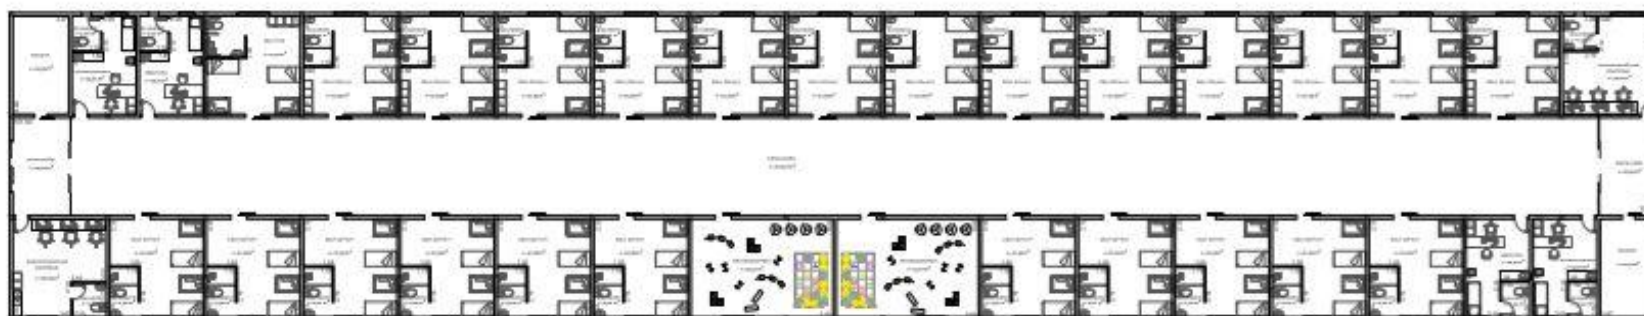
Planta Humanizada – Fonte: Acervo Próprio
